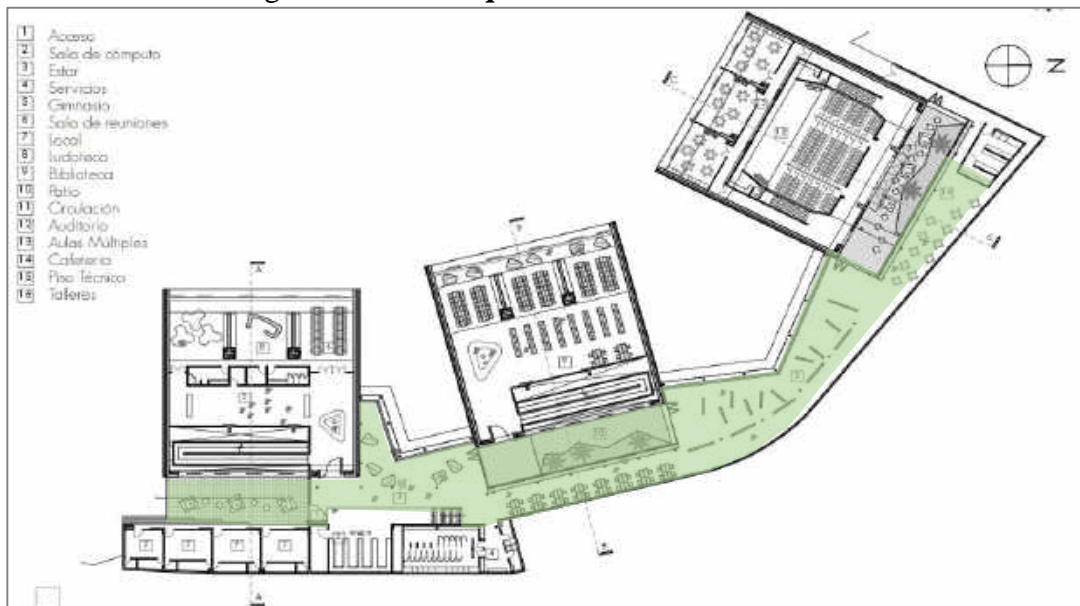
Primera Planta – Parque Biblioteca León de Grieff
